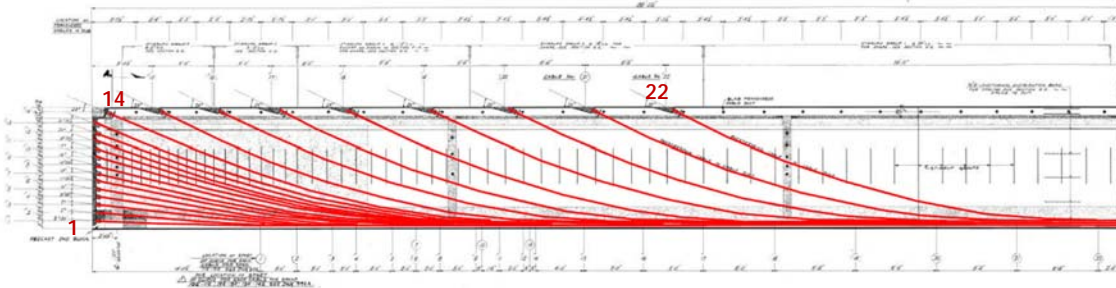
Vue en élévation d'une poutre de la section 7B – travée 11E-12E
